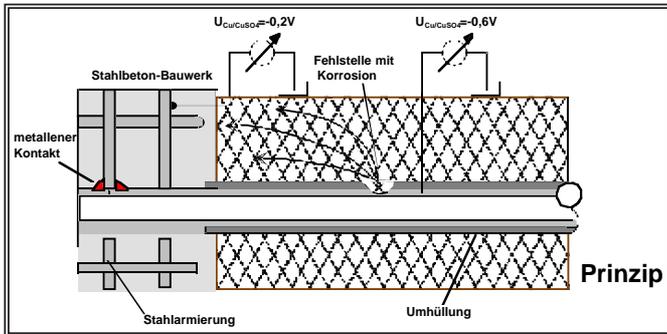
Prinzip eines Kontaktelementes Stahl in Beton/Stahl in Boden
